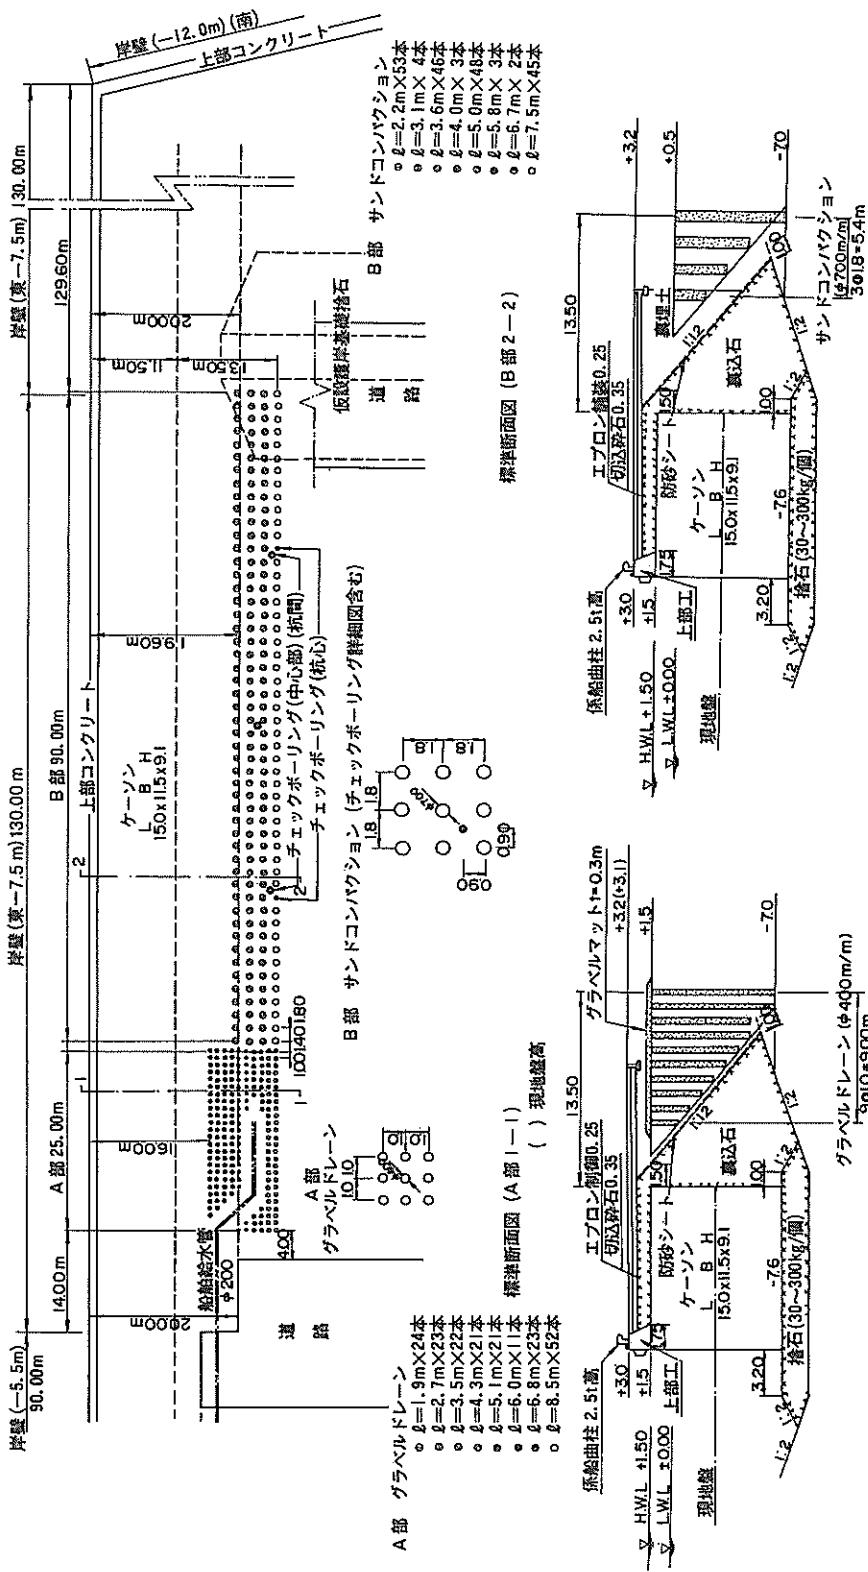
液状化対策平面図・断面図（第三埠頭地区、③東側岸壁（-7.5m））
